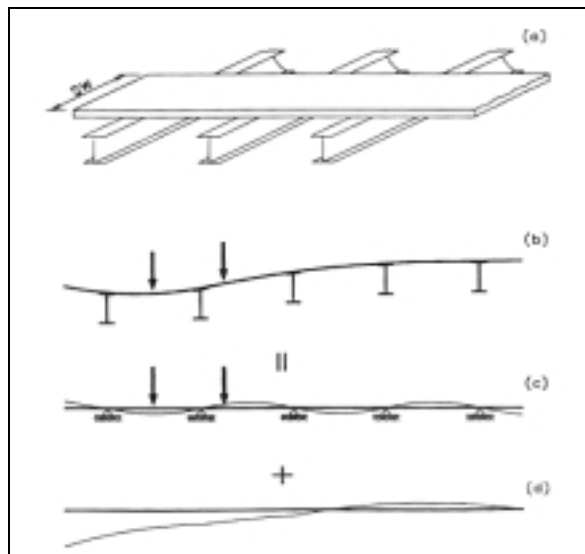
(a) Franja de diseño idealizada, (b) sección transversal bajo la carga, (c) modelo de viga rígida, y (d) desplazamiento debido a la traslación de la viga.
